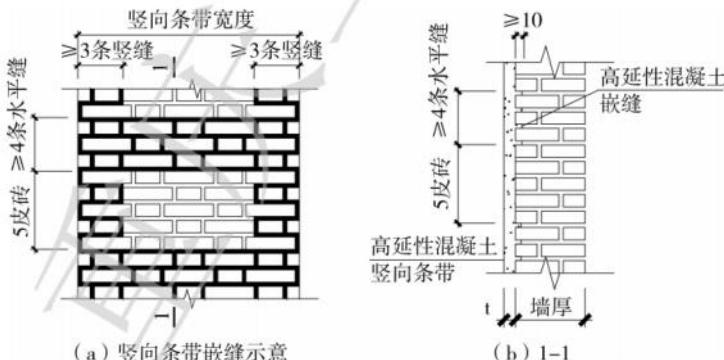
高延性混凝土竖向条带嵌缝示意图
